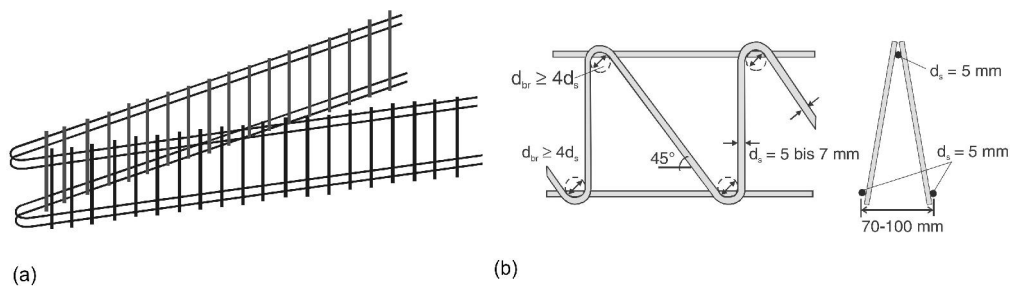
Sistemas de armaduras de punçoamento: (a) "Riss-Star-Ellement"; (b) "Lattice girder" [7].
